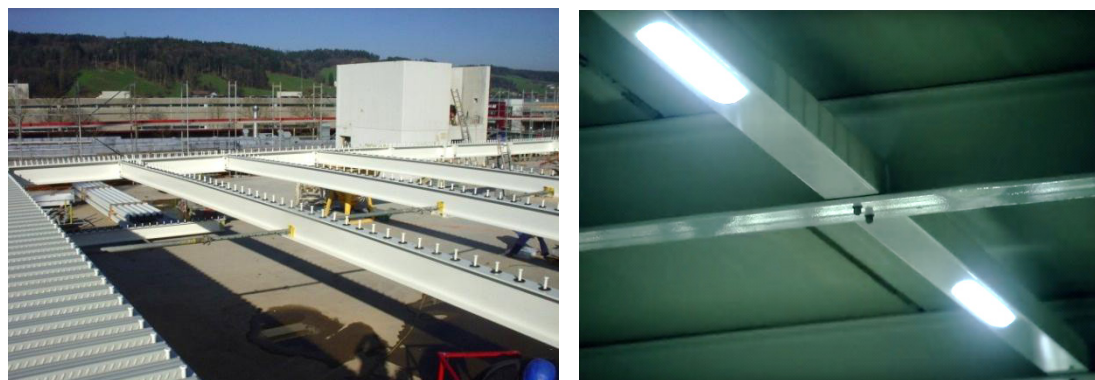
Временные и многофункциональные связи балок сталежелезобетонных перекрытий на этапе строительства
